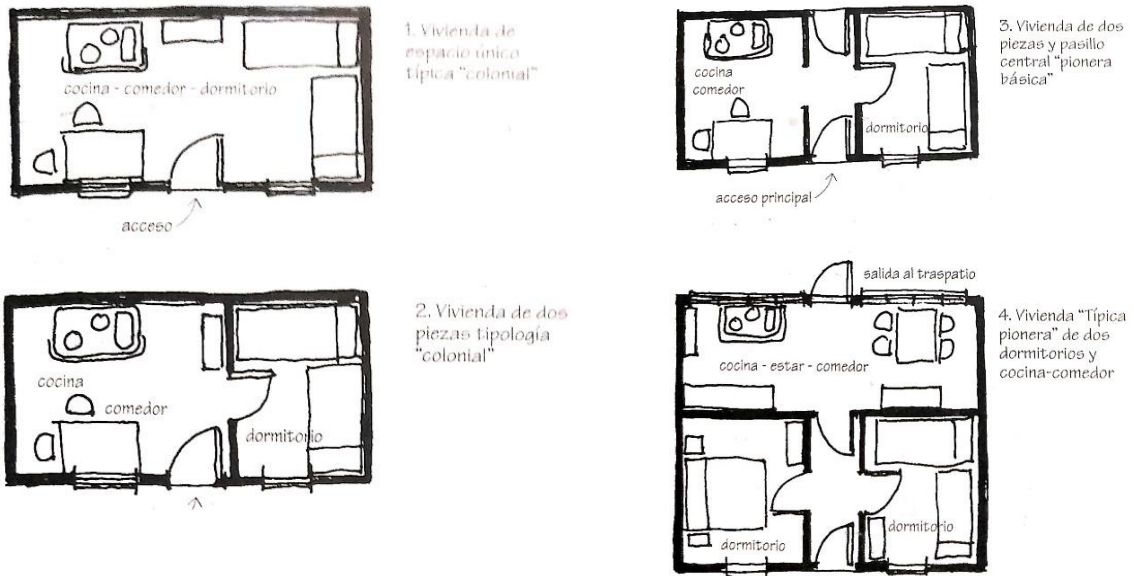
y 24: Evolución de una planta tradicional de la vivienda típica Colonial a sus posibles variantes y ampliaciones que presentan las plantas de corte Pionero
